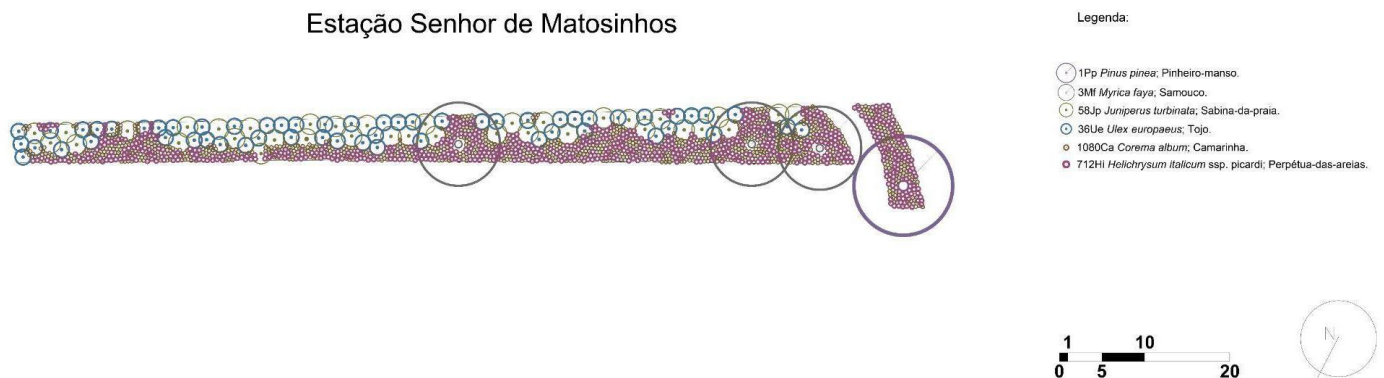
Plano de Plantação estação Senhor de Matosinhos (Fonte: Autor)
